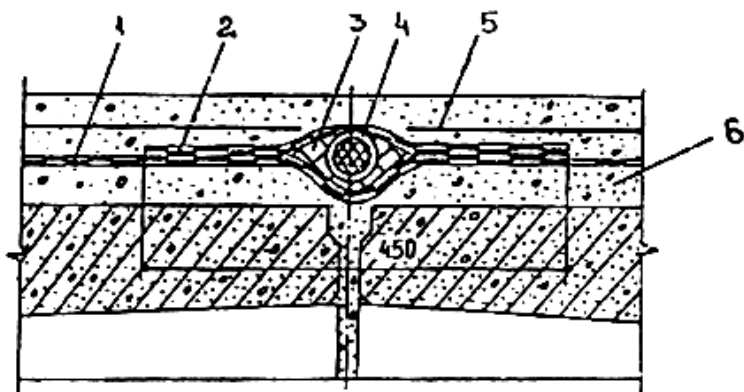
Конструкция гидроизоляции деформационного шва между плитами перекрытия:
